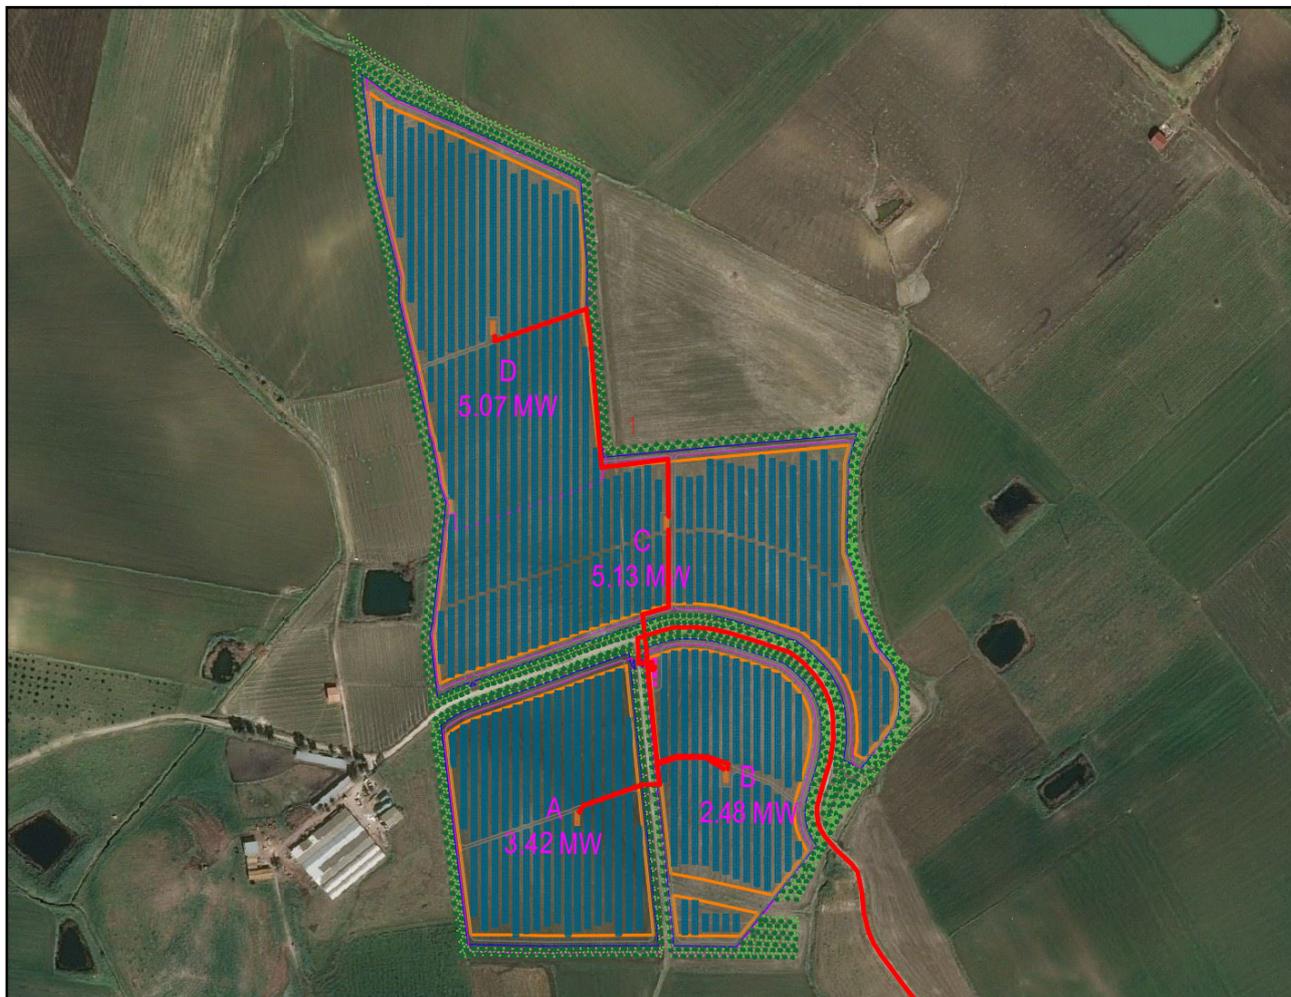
Layout di progetto e suddivisione dei sottocampi su ortofoto
